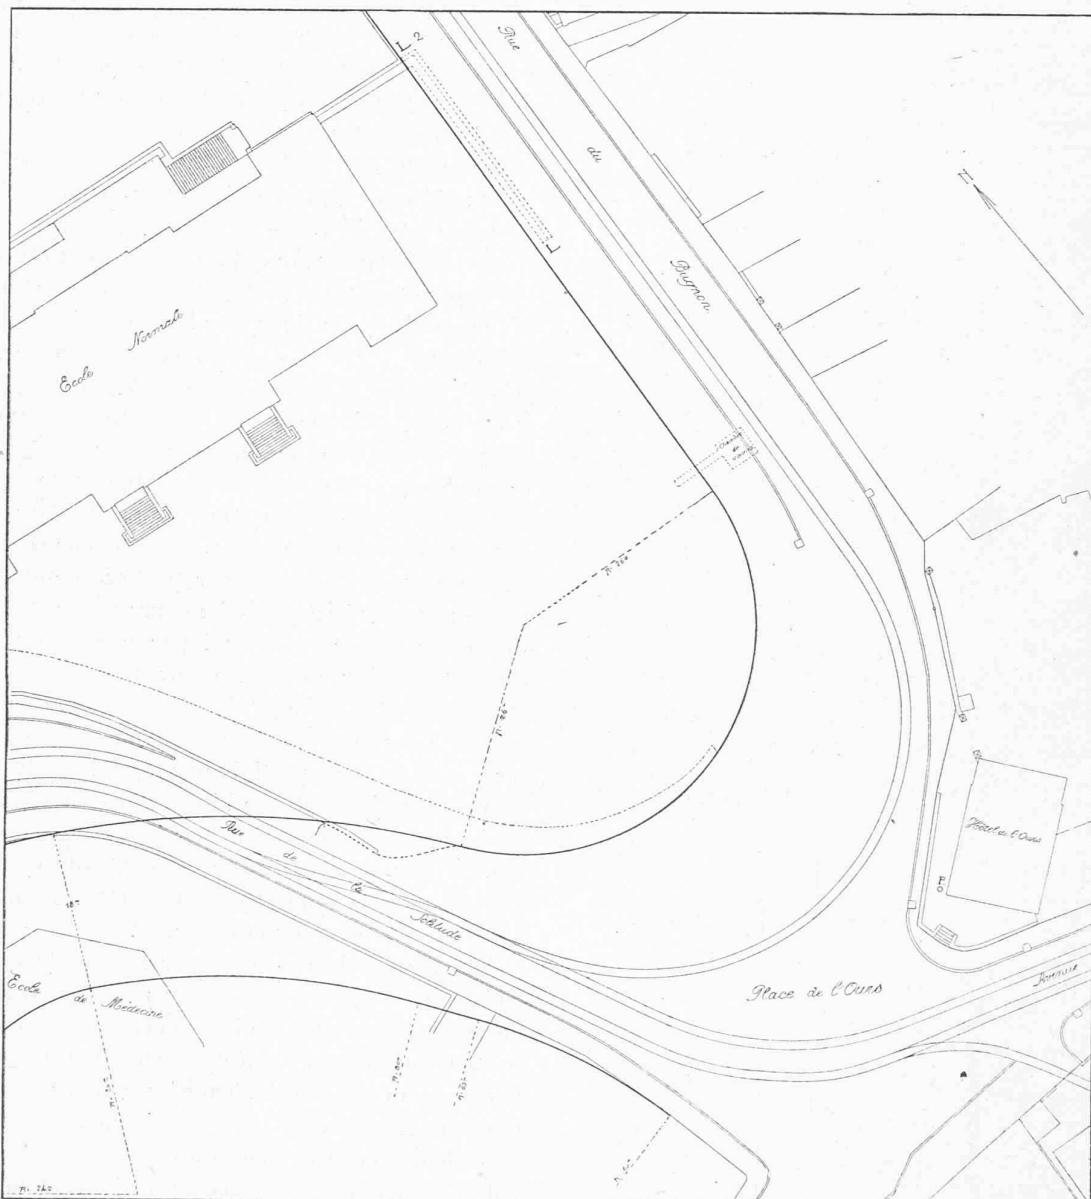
Plan de situation. — Echelle 1 : 800.
